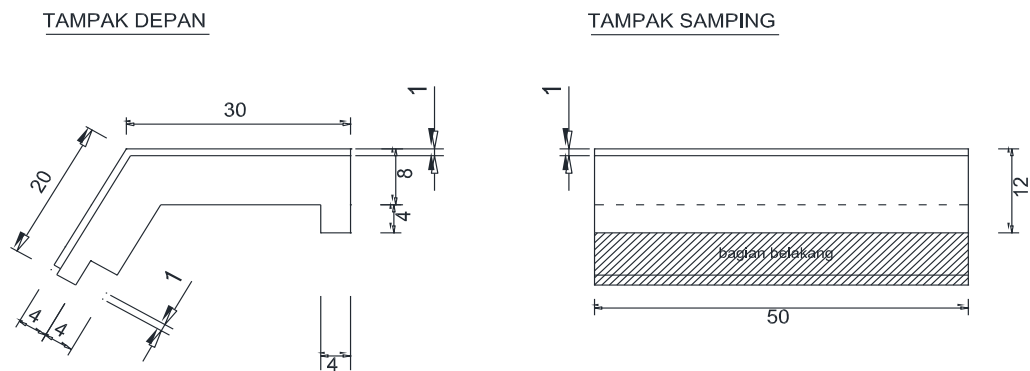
Modul Dinding atau Lantai Tipe-S Beton Pracetak Modular
